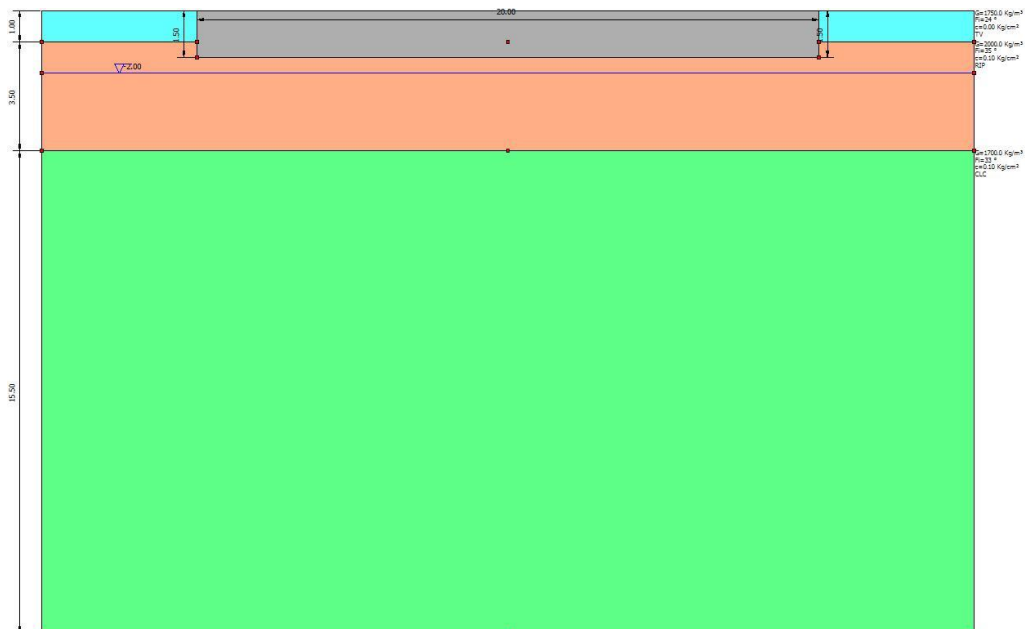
Sezione stratigrafica di calcolo della piastra di fondazione
